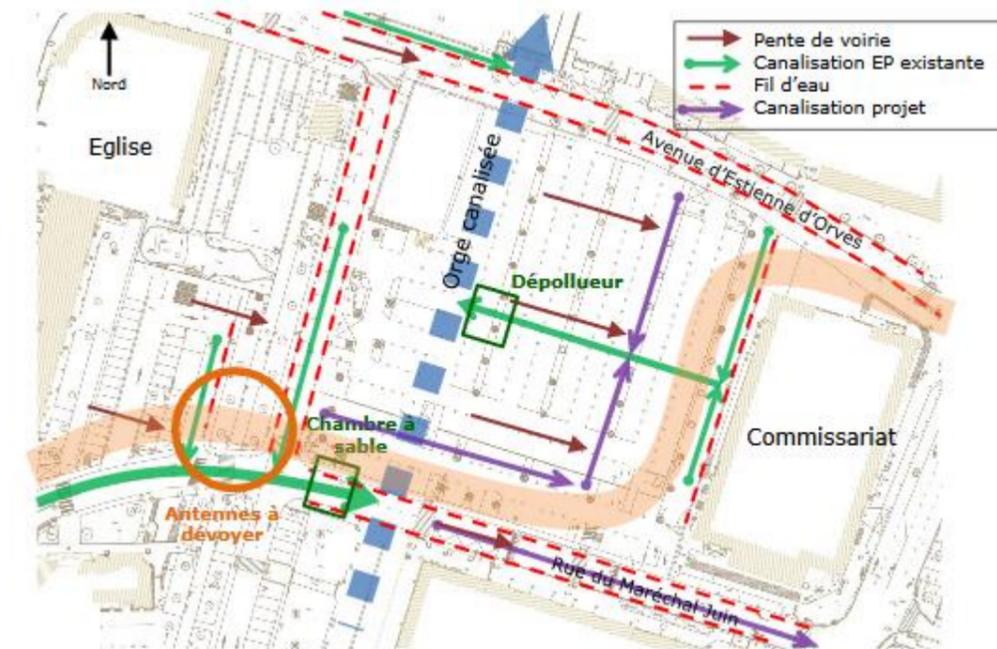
Schéma explicatif du système d'assainissement projeté sur la place Maréchal Leclerc
